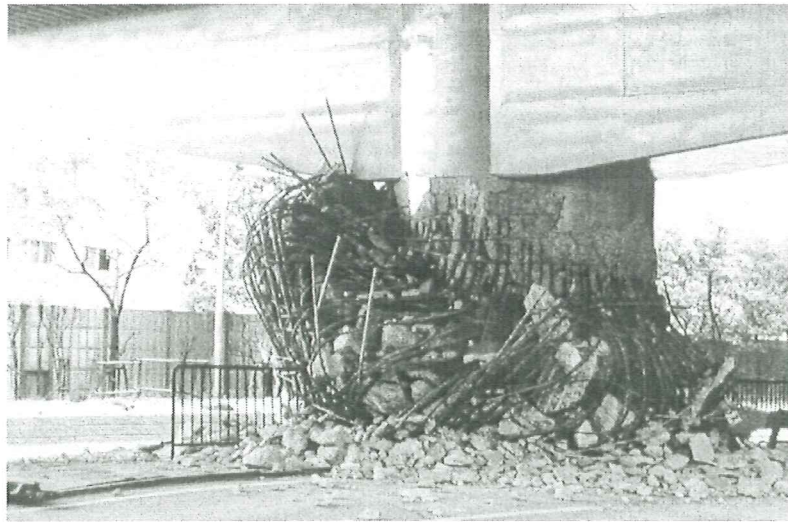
Esta foto muestra una falla a compresión de una pila de hormigón armado, Nishinomiya, (Architectural Institute of Japan Society of Civil Engineers).
